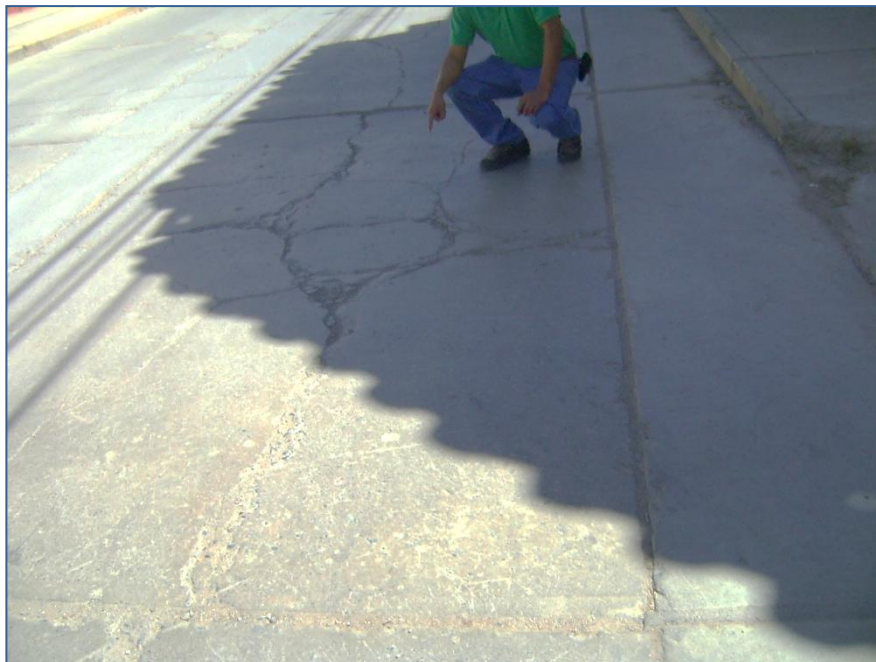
En la vista se puede apreciar la severidad de la losa dividida en este caso es alto. Av. 20 de enero
